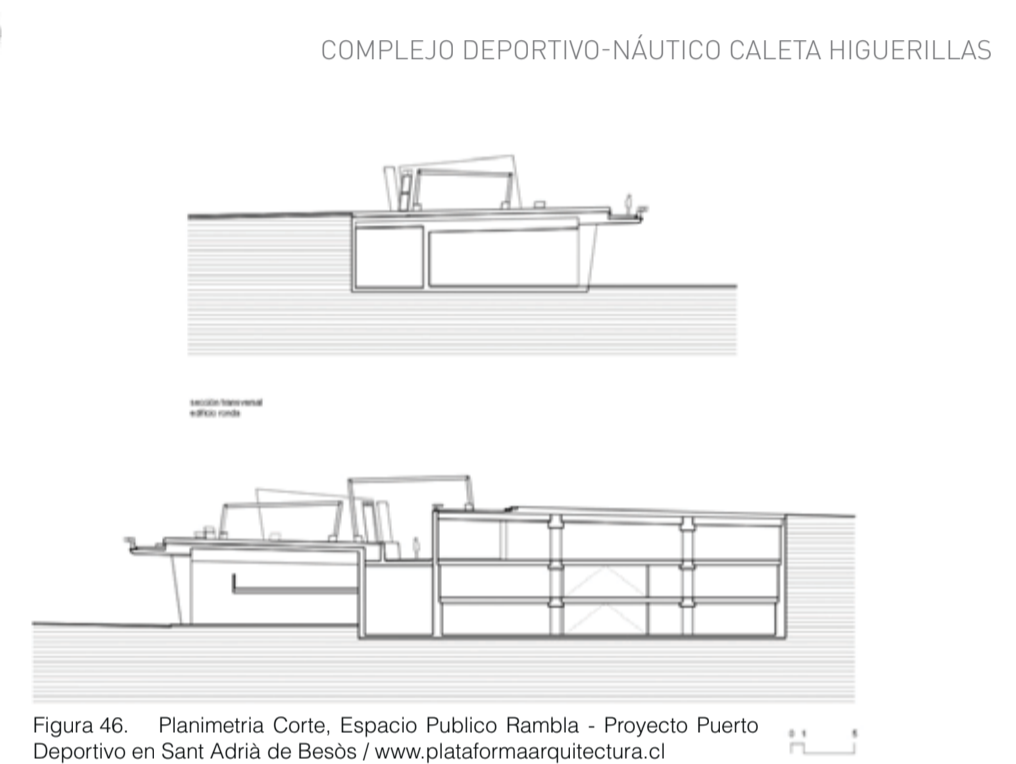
Planimetría Corte, Espacio Publico Rambla - Proyecto Puerto Deportivo en Sant Adrià de Besòs / www.plataformaarquitectura.cl
